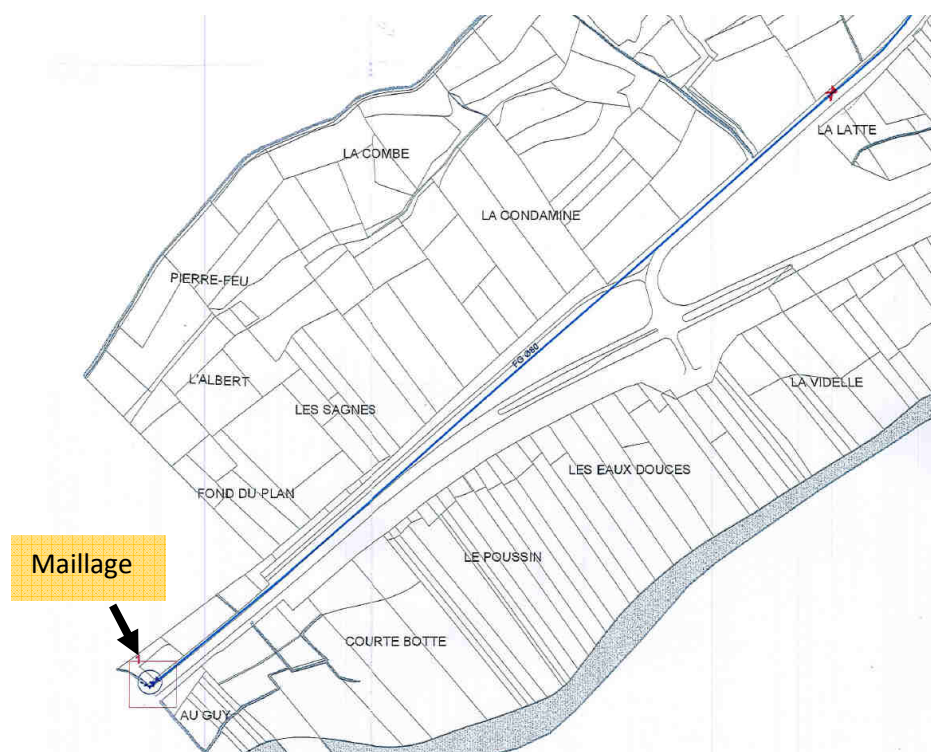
LOCALISATION DE LA CONDUITE AU DROIT DU PROJET
